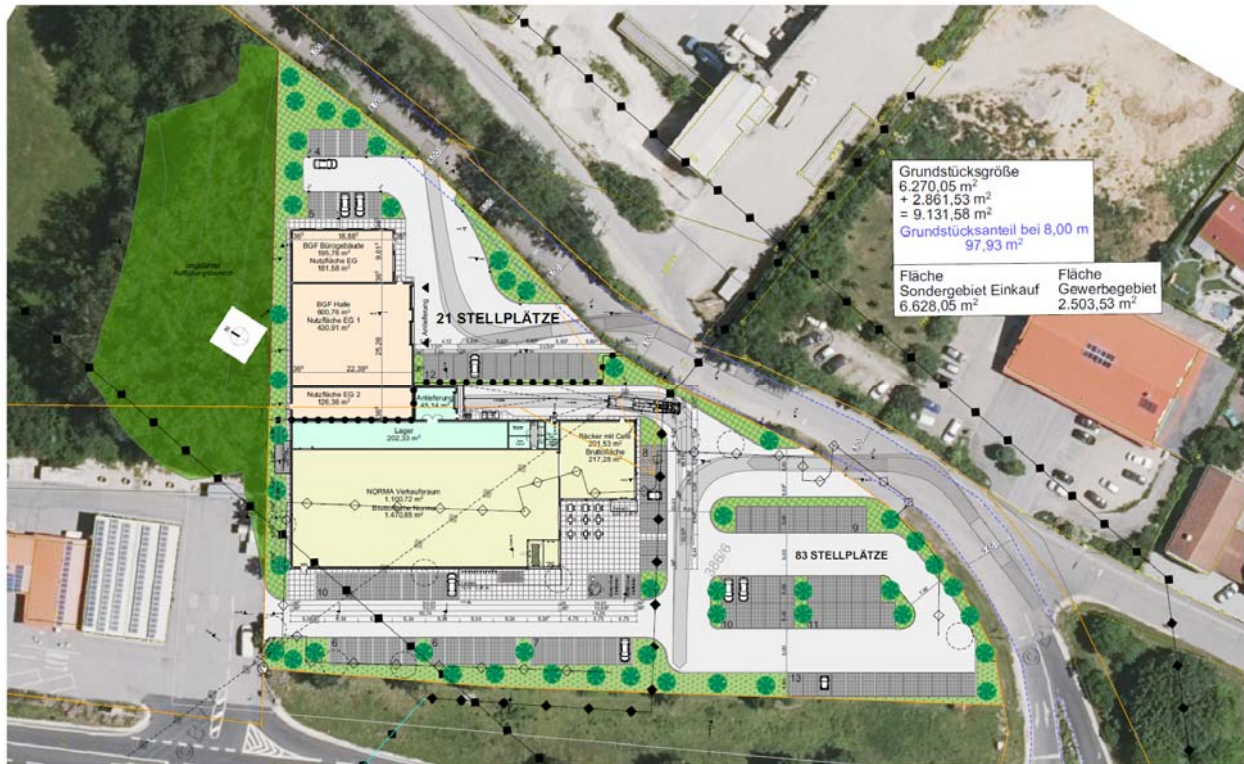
Ausschnitt aus NEUBAU EINES NORMA LEBENSMITTELMARKTES MIT BÄCKER / CAFE UND NEUBAU EINER HALLE MIT 2-GESCHOSSIGEN BÜROGEBÄUDE, Eingabeplan, Planstand 10.06.2021, Planverfasser: ZISSLER ARCHITEKTUR GMBH, BERNHARDSWALD
